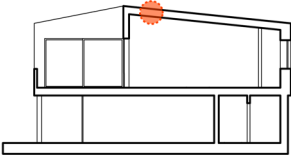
Dachkonstruktion | Variante 01-03 | M 1:10
